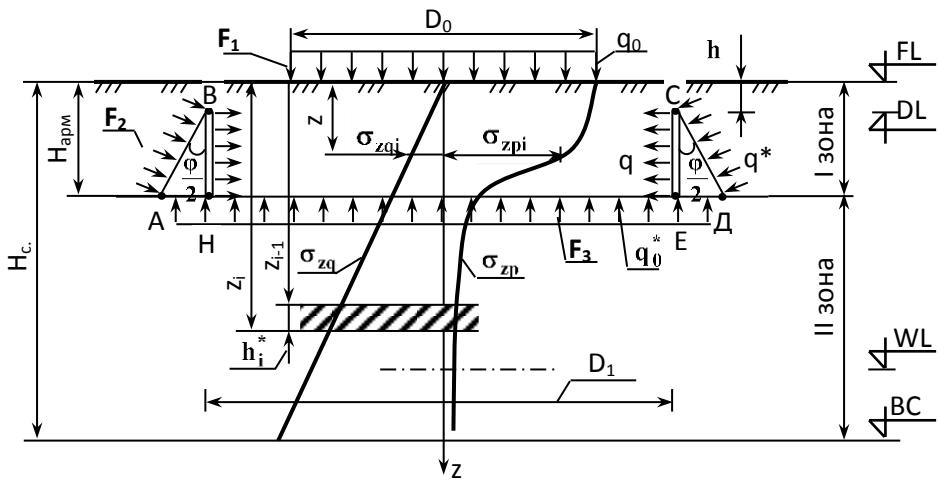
Расчетная схема грунтового основания РВС армированного кольцевой системой с активным преднапряжением грунта, где АВСД – зона активного армирования грунта; q_0 – вертикальное давление от днища РВС; q – давление от горизонтального преднапряжения грунта; q_0^* – трансформированное вертикальное давление от внешней нагрузки, соответственно на площадь F_3 ; q^* – трансформированное давление горизонтального преднапряжения, соответственно на площадь F_2 ; F_1 – площадь рабочего днища РВС; F_2 – боковая площадь сопряжения кольцевой системы армирования с окружающим грунтом; F_3 – увеличенная площадь передачи внешней нагрузки от РВС на II зону неармированного грунта; D_0 – рабочий диаметр гибкого днища РВС; D_1 – диаметр системы кольцевого армирования грунта; H_c – активная глубина сжимаемой толщи грунта; $H_{\text{арм}}$ – глубина кольцевого армирования грунта
